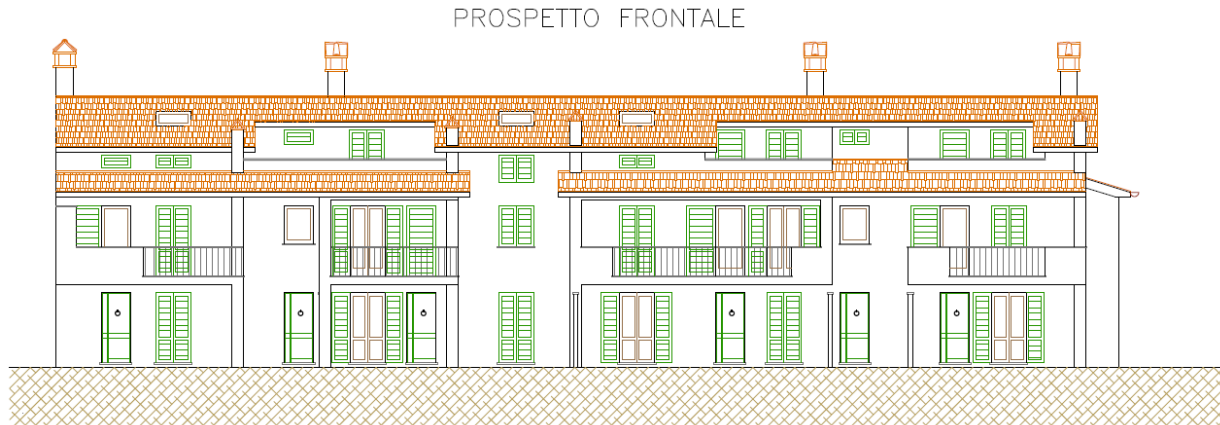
DESCRIZIONE DELL'INTERVENTO – PROSPETTO FRONTALE
